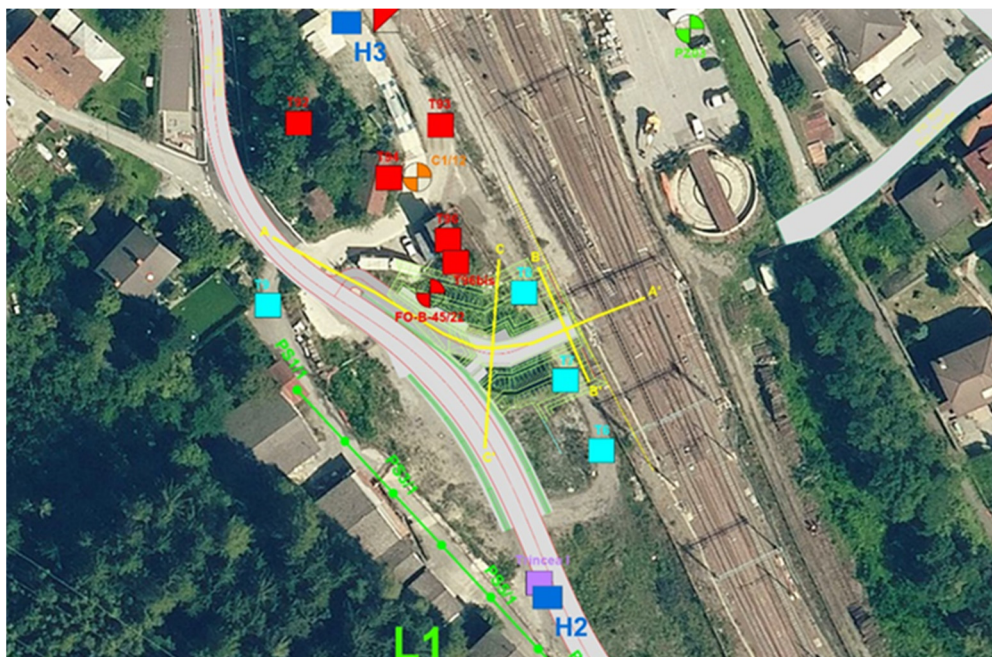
Planimetrie mit Lage der geognostischen Untersuchungen
